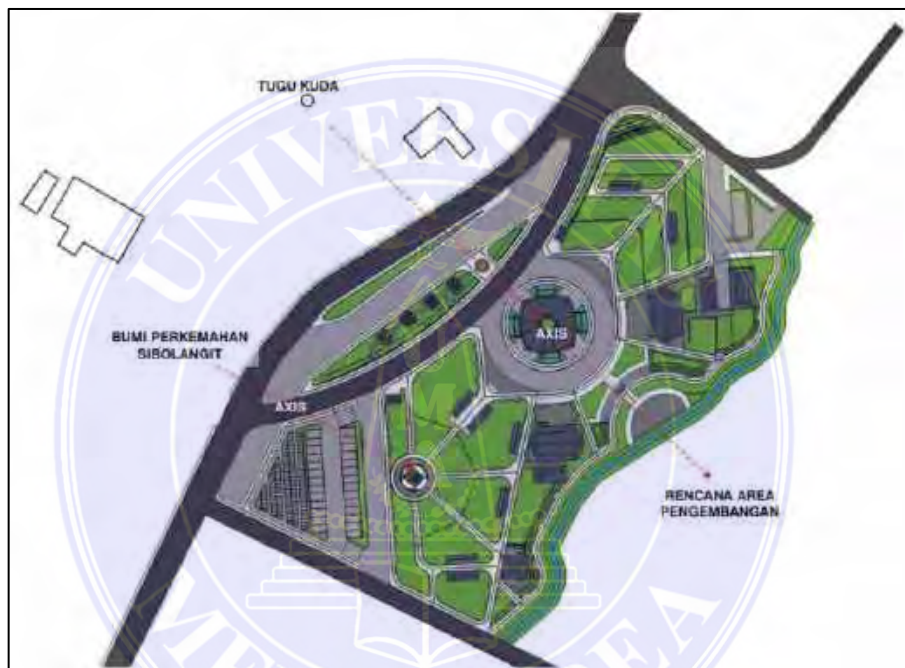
26 Site Plan Taman Bunga Sibolangit (Sumber: Cavatina Studio)
